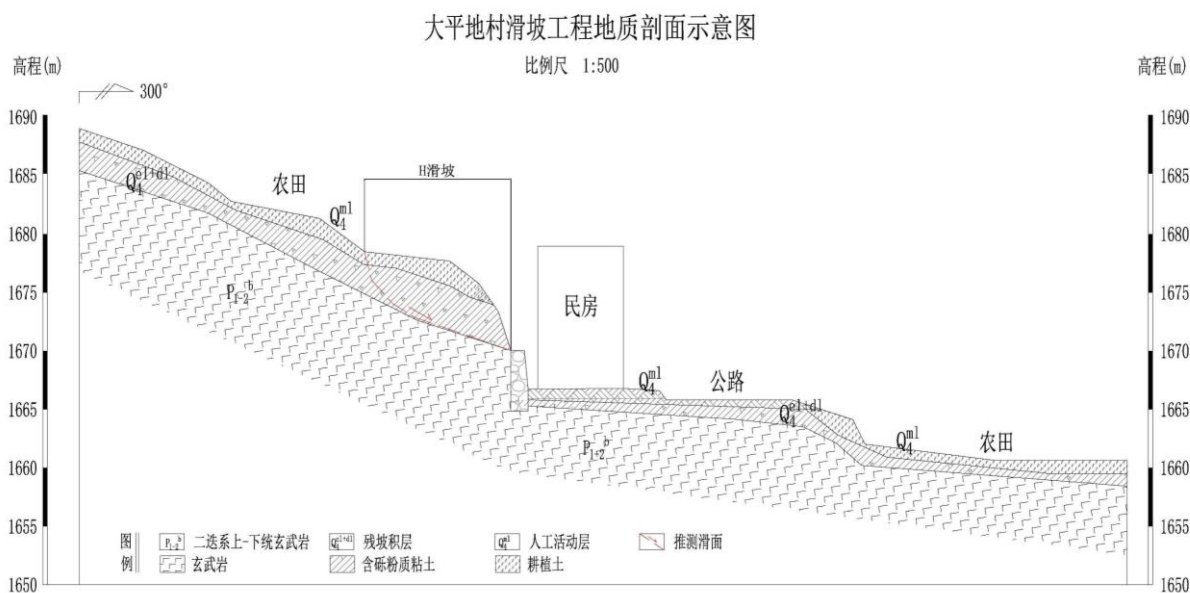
大麦地村滑坡工程地质剖面示意图
